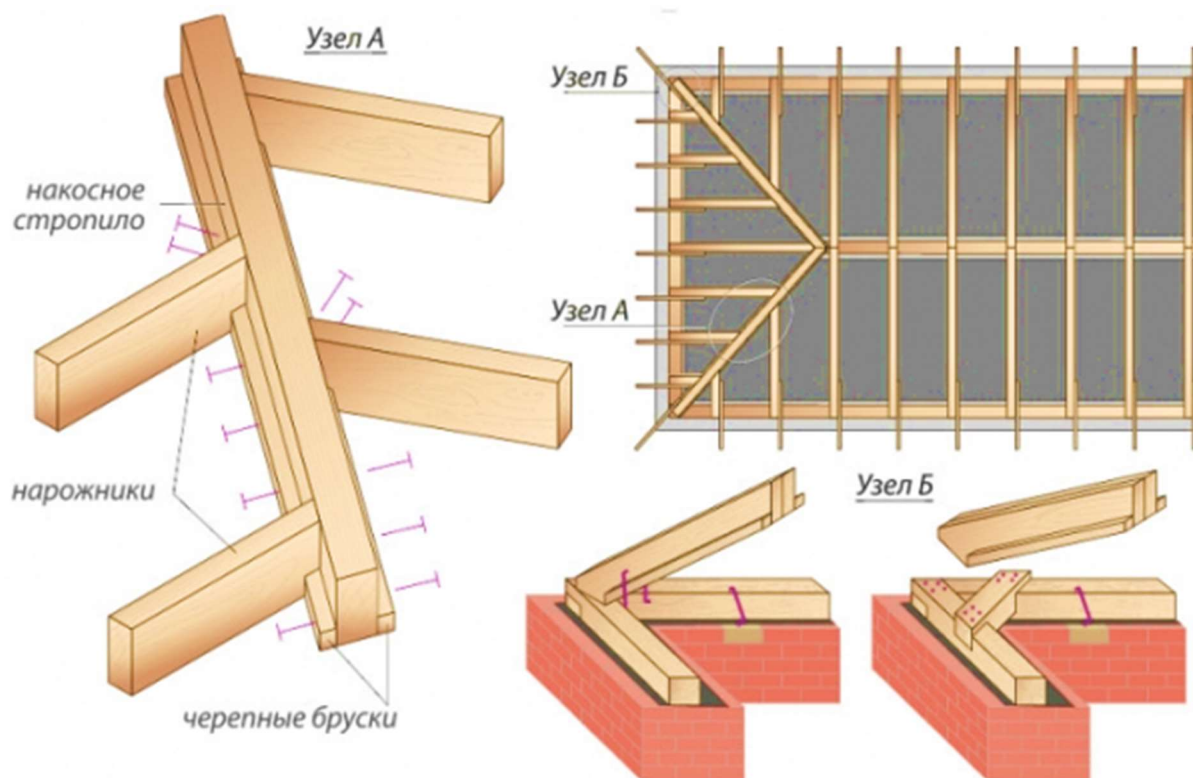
План стропил двускатной вальмовой крыши с элементами крепления
